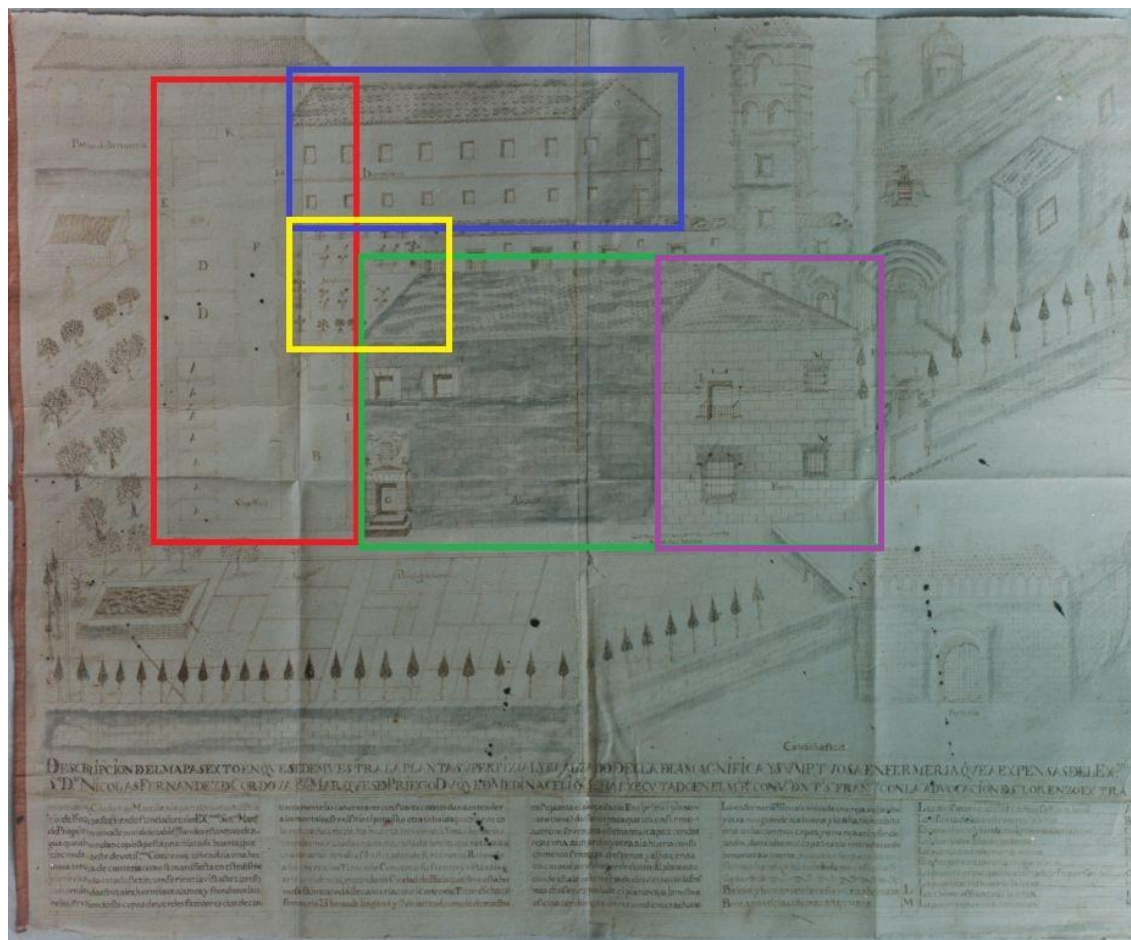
JUAN ANTONIO CAMACHO. *Descripción del plano sexto...* (señalamiento de la planta y alzados de la enfermería). Fuente:
